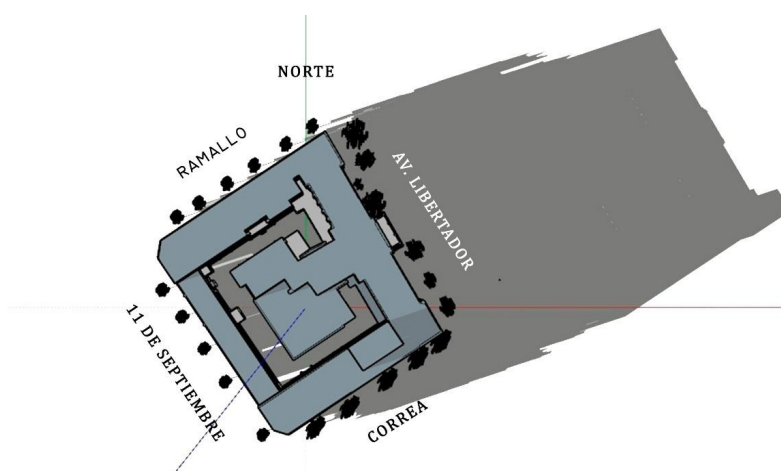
Vista en Planta del Edificio de CNEA por la Tarde.
